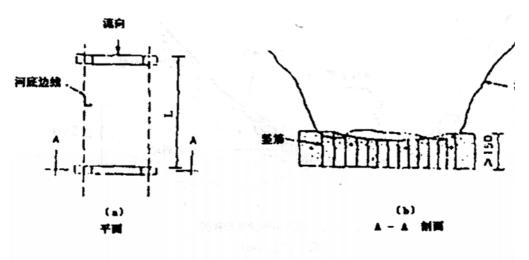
肋板平面布置及剖面示意图 (尺寸单位: cm)
